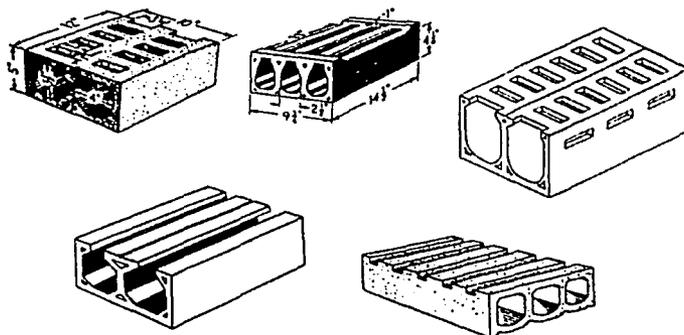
Tipos de bloques de drenaje de concreto precolado.
